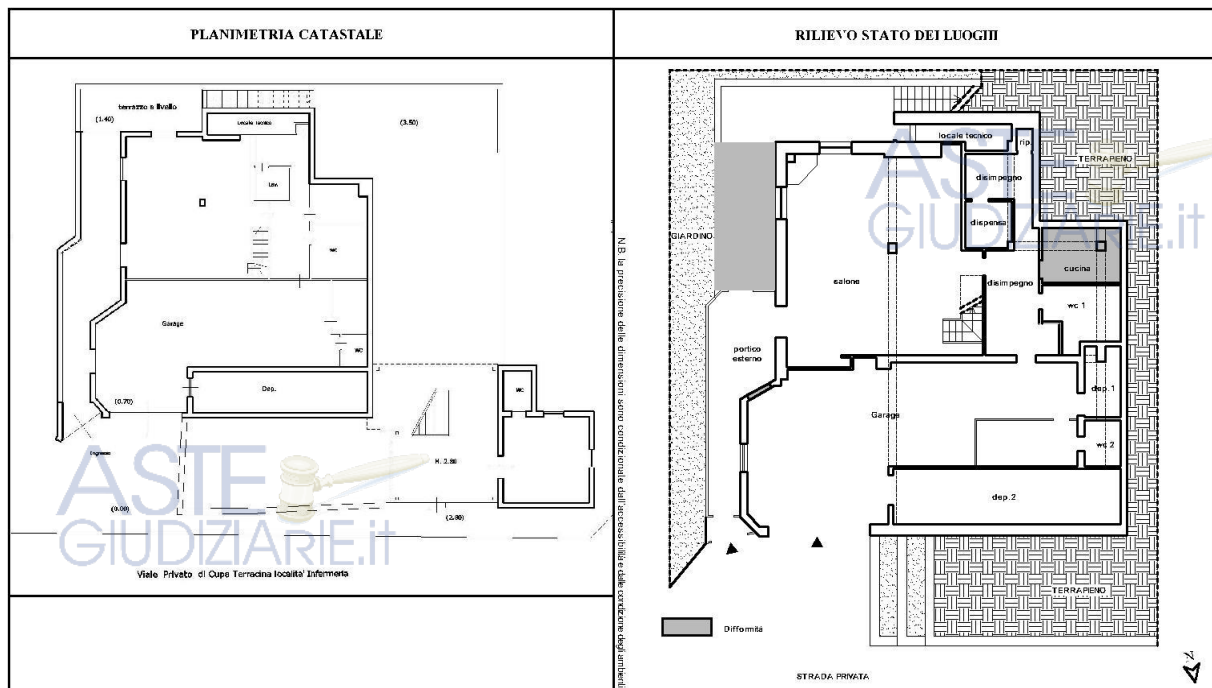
Confronto tra lo stato dei luoghi Piano Terra e la planimetria catastale attuale
